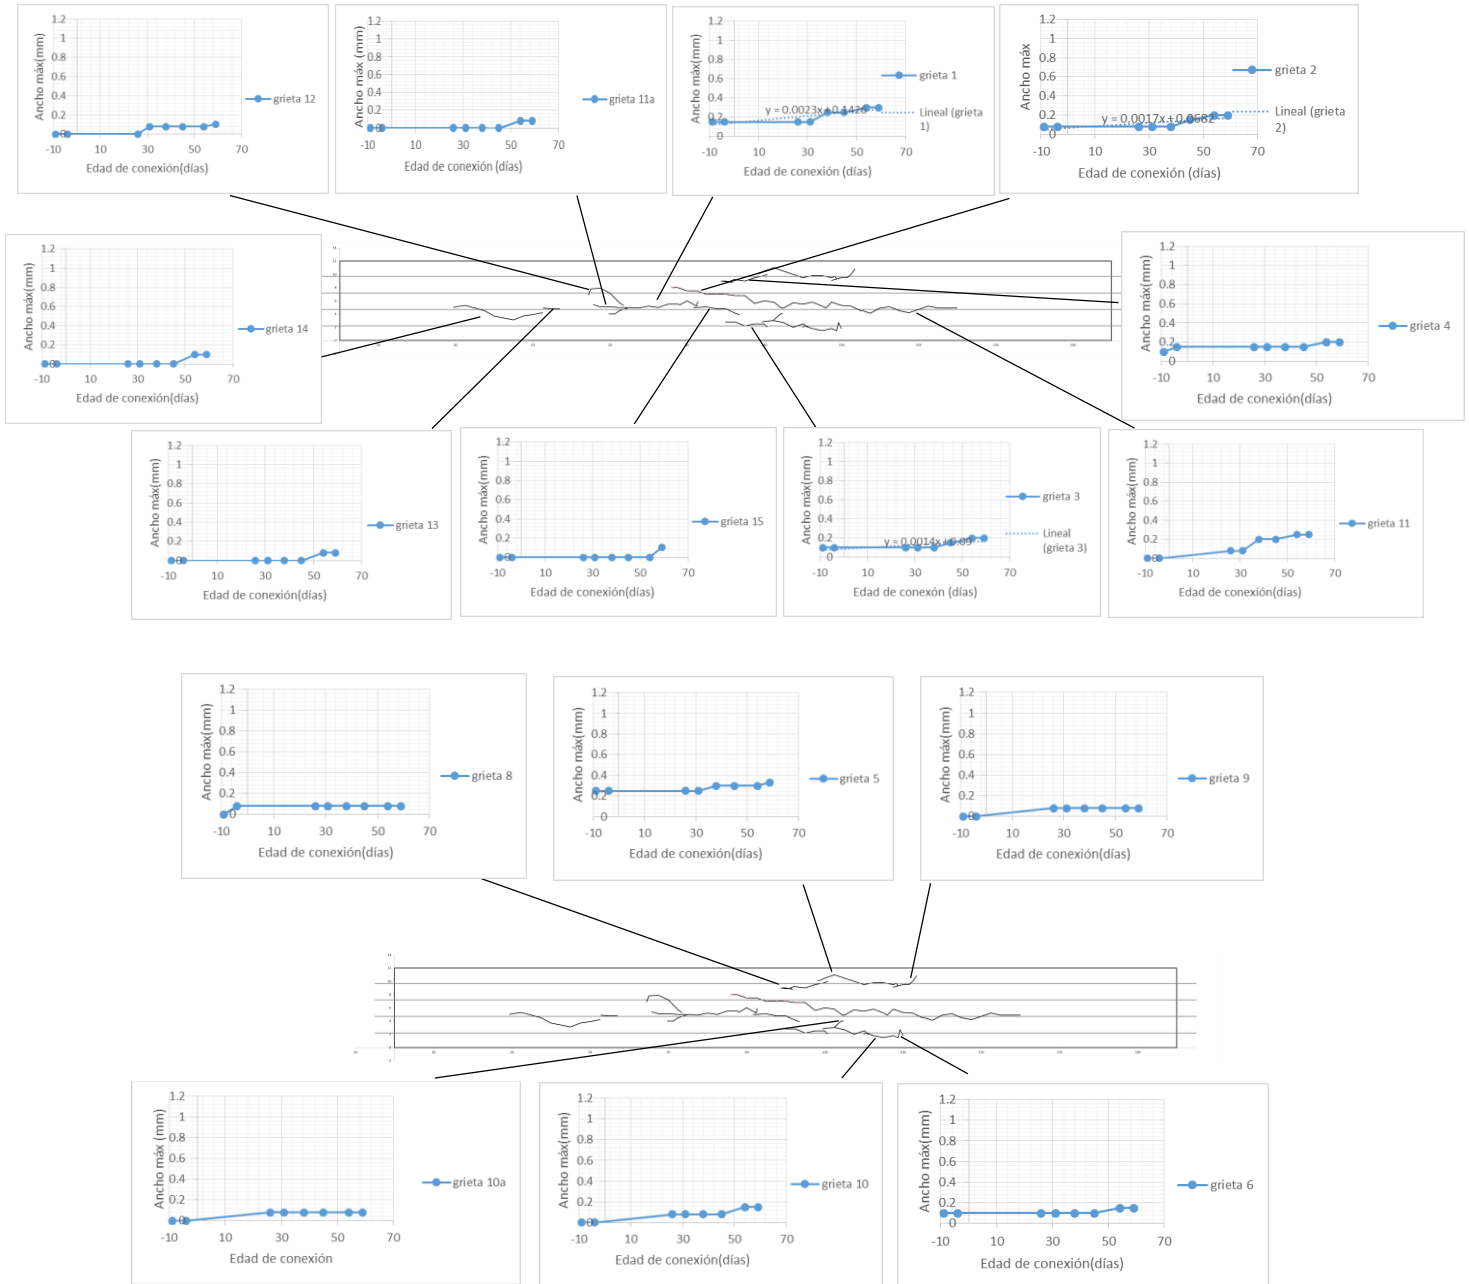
Localización y ancho máximo de grietas viga VCPCI.
